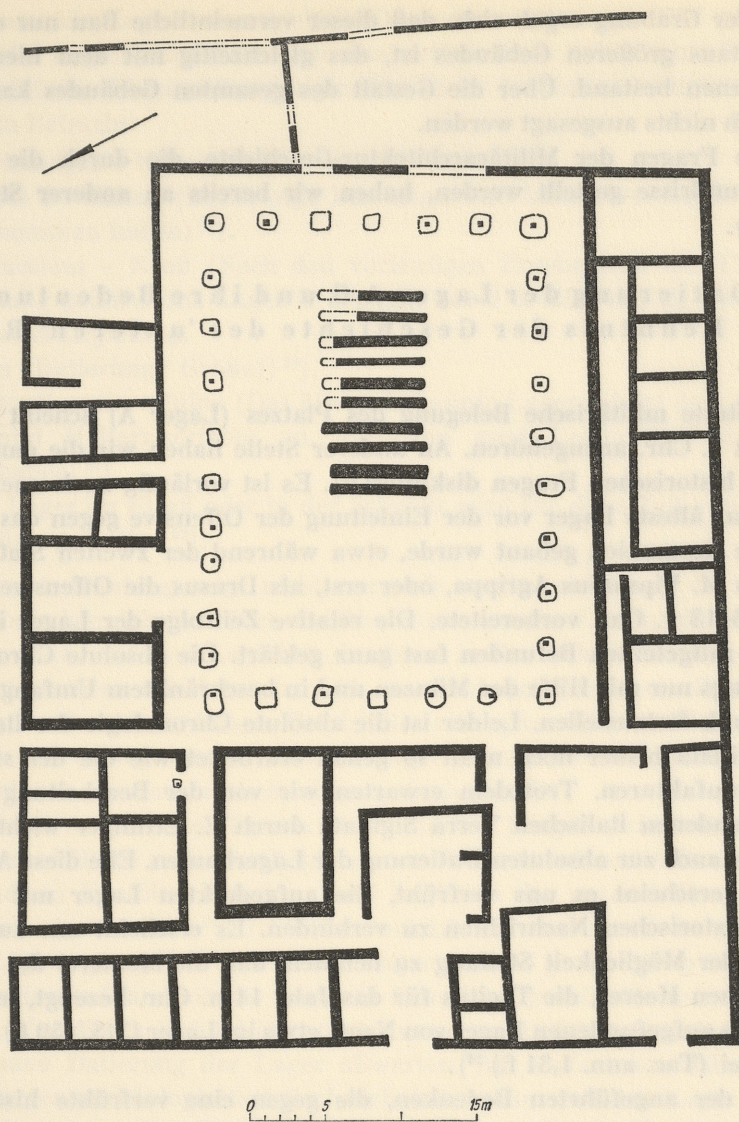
Grundriß eines Mittelgebäudes des Lagers F (?) in Neuß.
